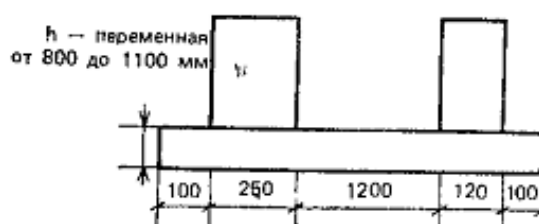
Стенки кирпичные, основание — бетон М100, наружная гидроизоляция — битум. Внутри по дну — цементная стяжка — 20 мм
